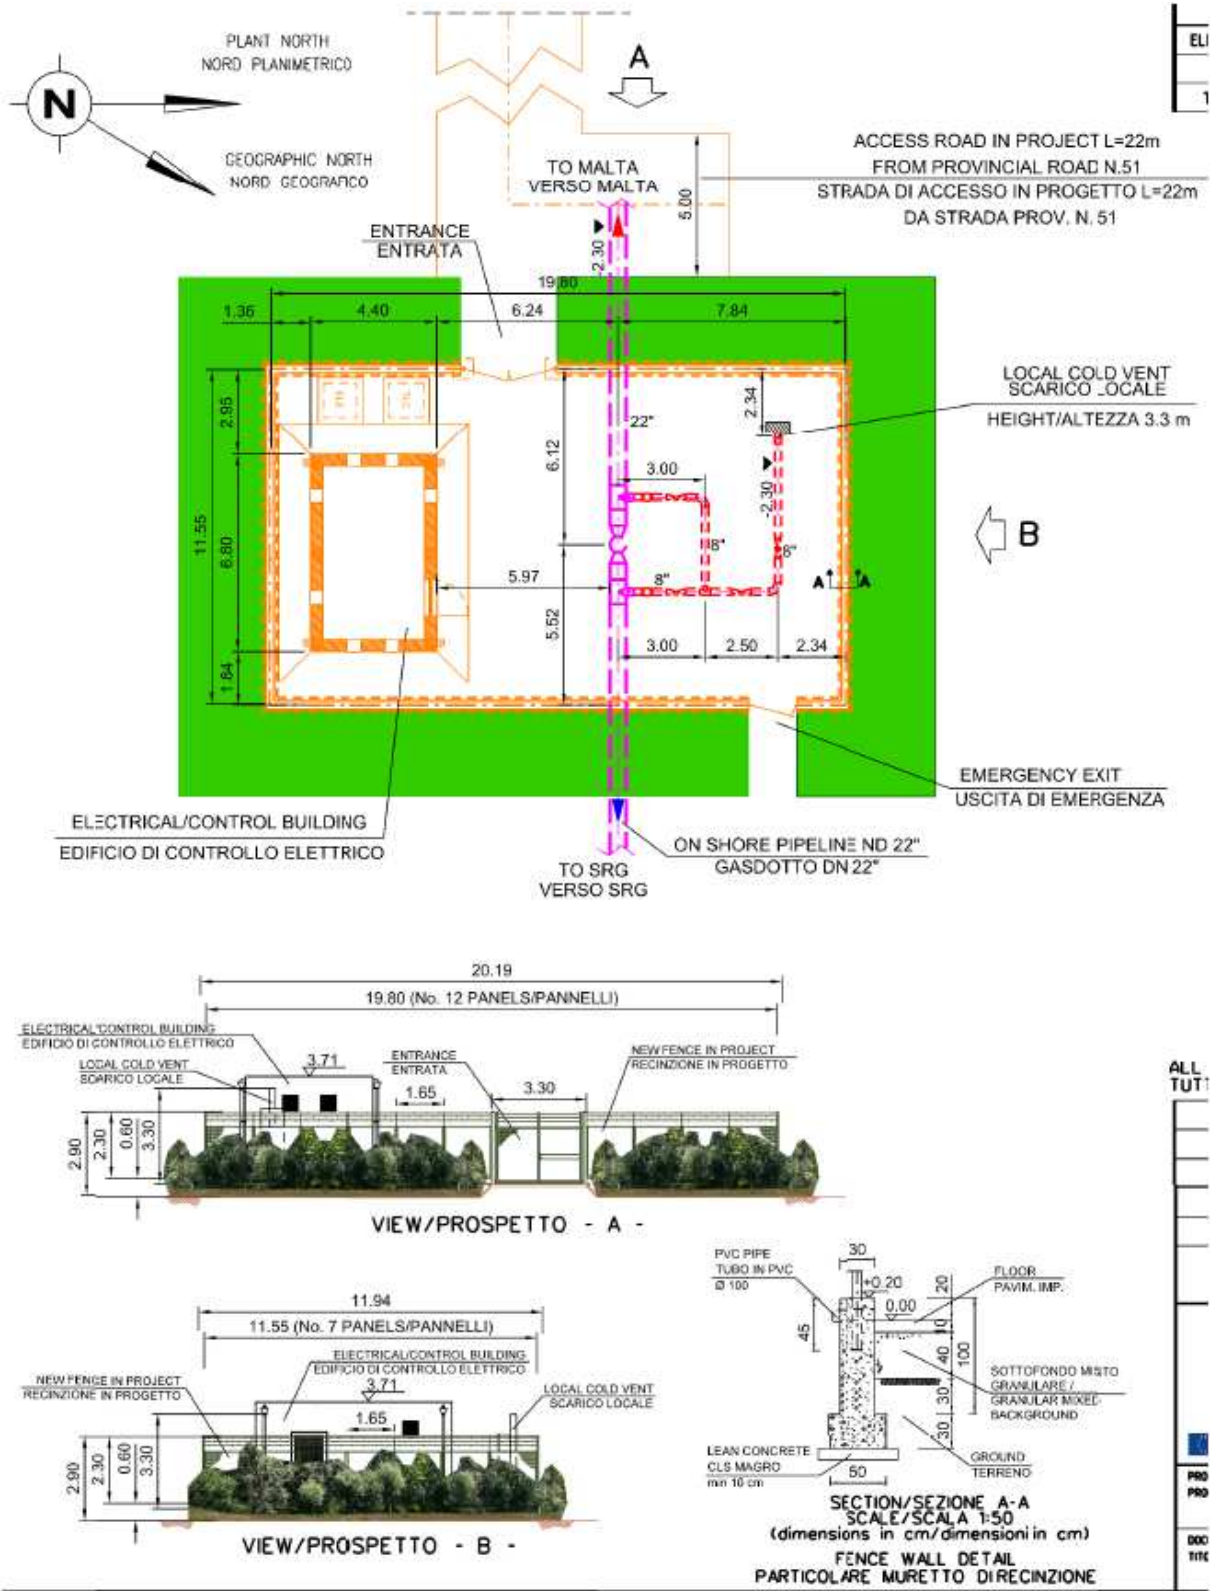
Punto di intercettazione di linea 2 – Planimetria e prospetti
